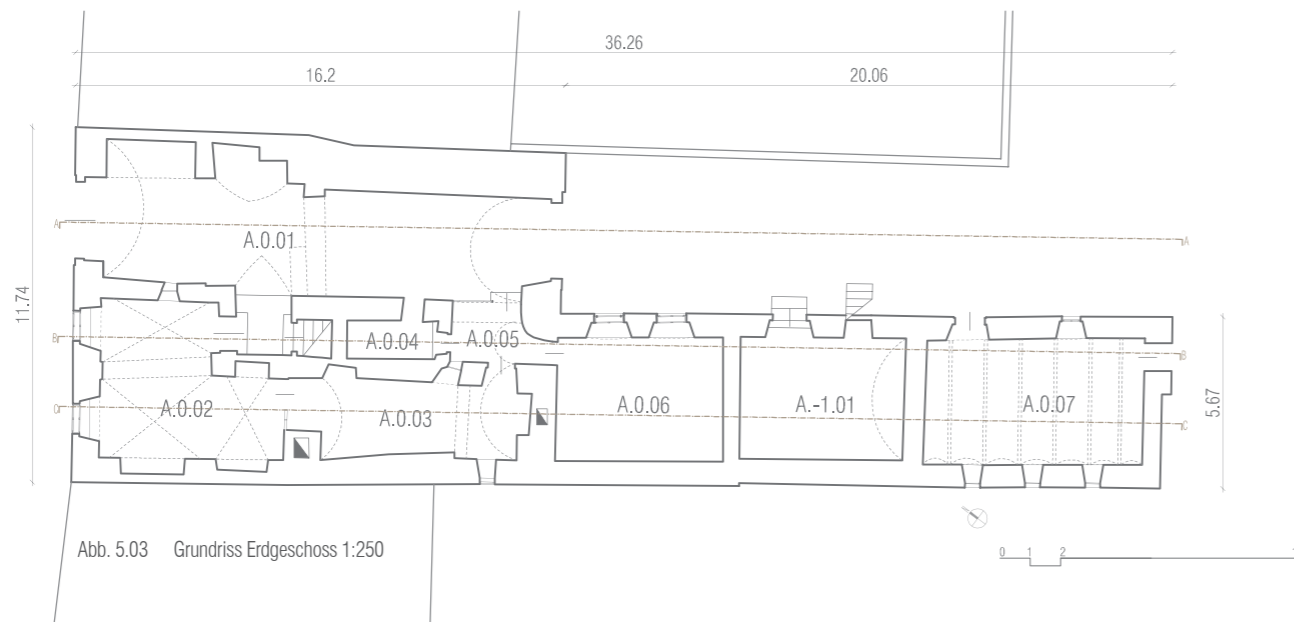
Grundriss Erdgeschoss 1:250
